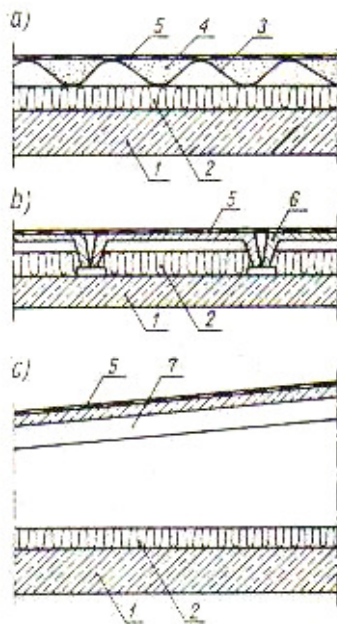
Konstrukcja stropodachu niewentylowanego [5]
